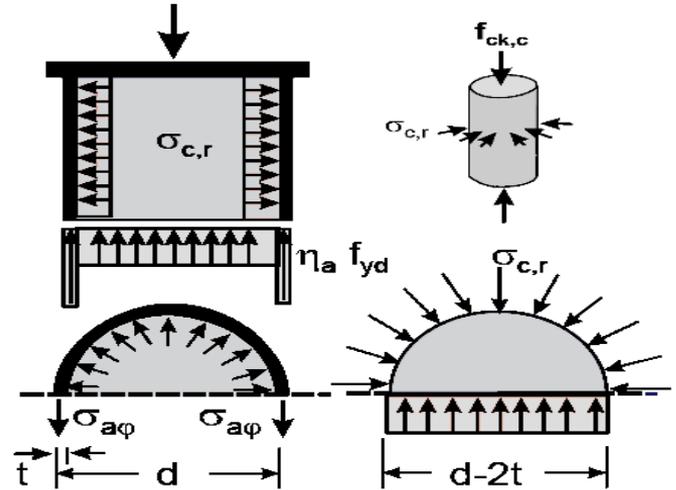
Иллюстрация эффекта от обжатия бетона в заполненных бетоном круглых трубах
